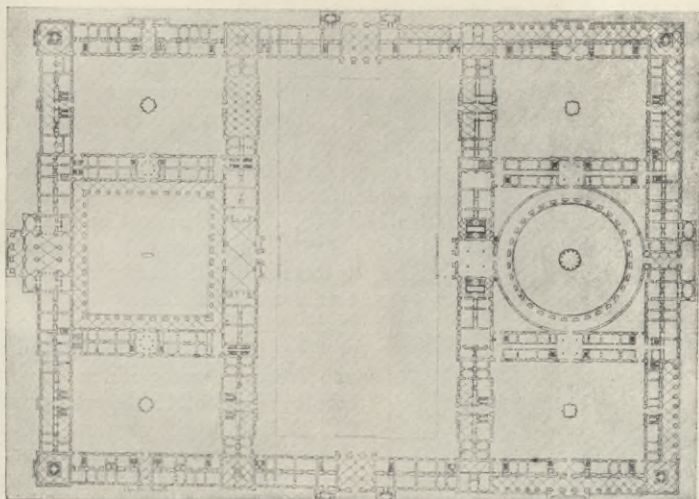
Inigo Jones' Grundrißentwurf für Whitehall.
